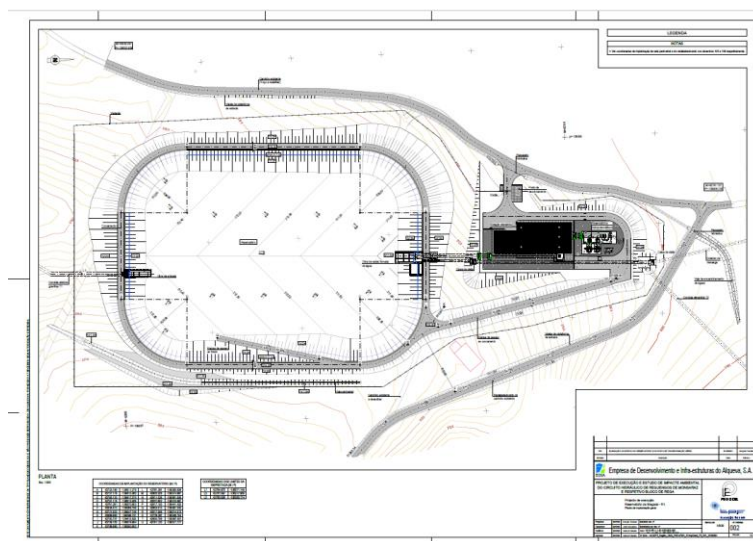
Planta do Reservatório e da Estação Elevatória da Bragada
